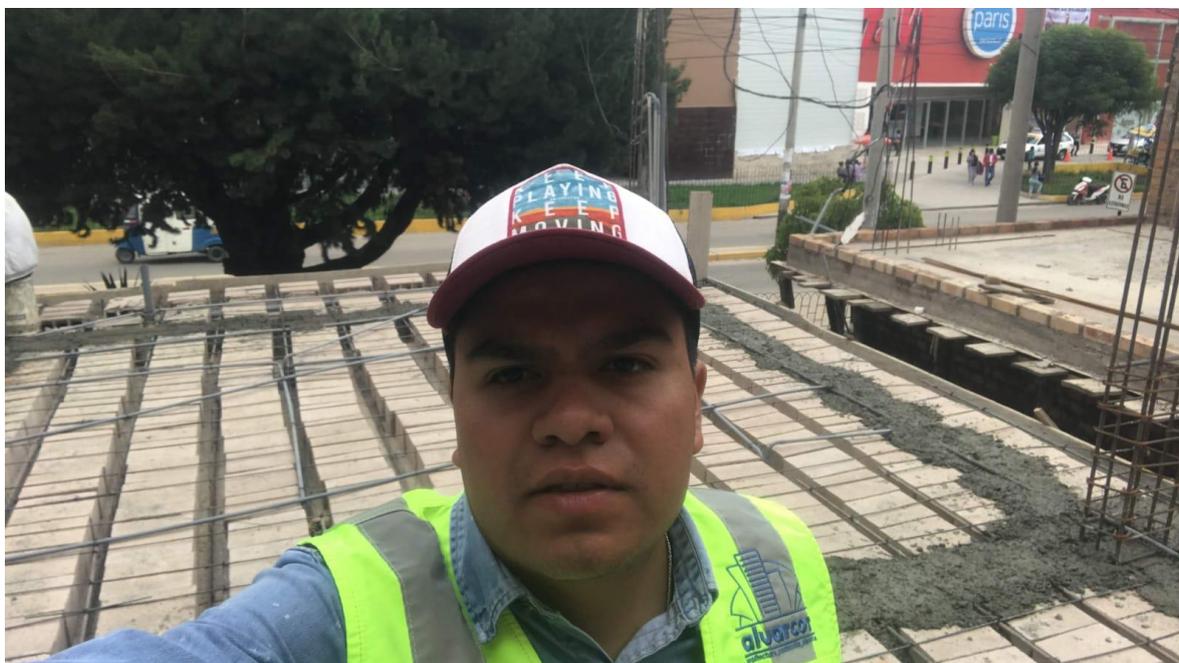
Proceso de construcción – instalaciones sanitarias y concreto en losa
